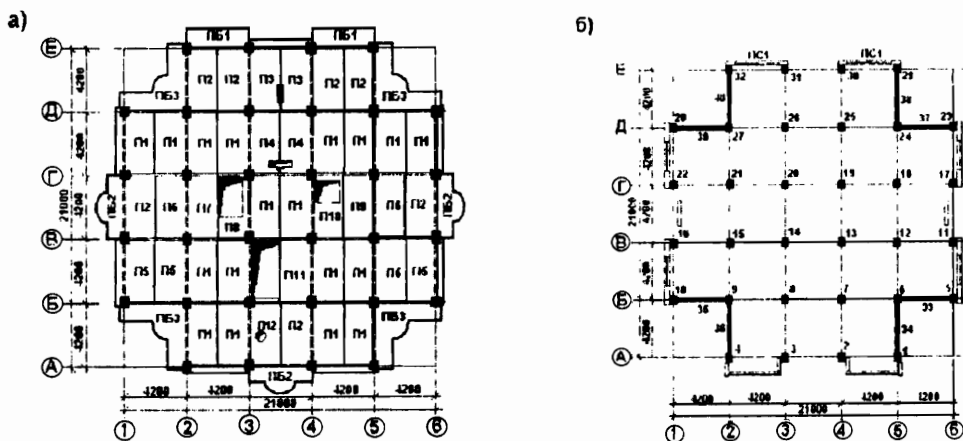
Конструктивно-технологические решения типового этажа: а – схема размещения элементов перекрытия; б – то же, колонн, диафрагм жесткости и наружных стеновых панелей (цифрами показана последовательность монтажа элементов)
